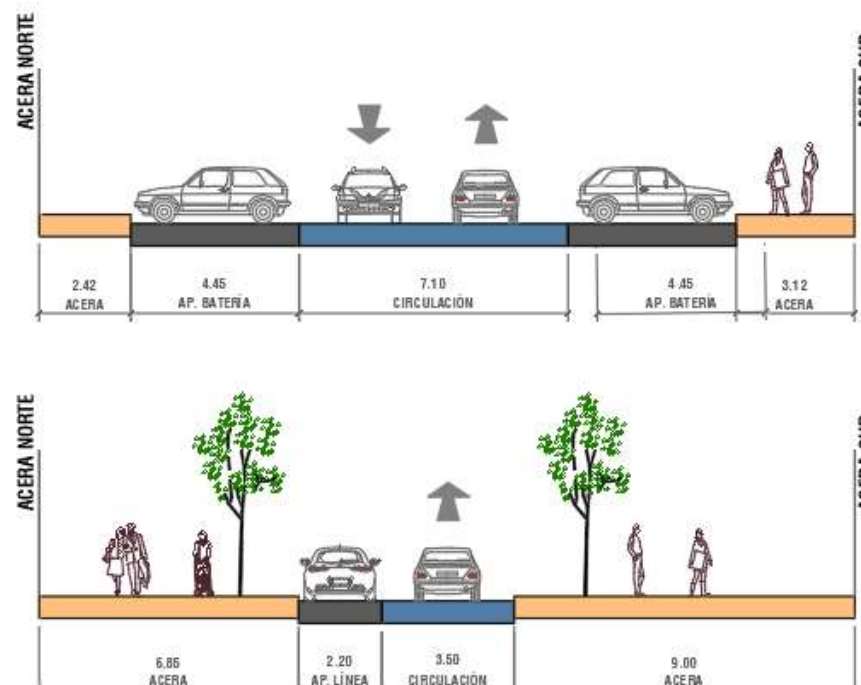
Sección tipo D propuesta en calle Real. Fuente: DOYMO.
